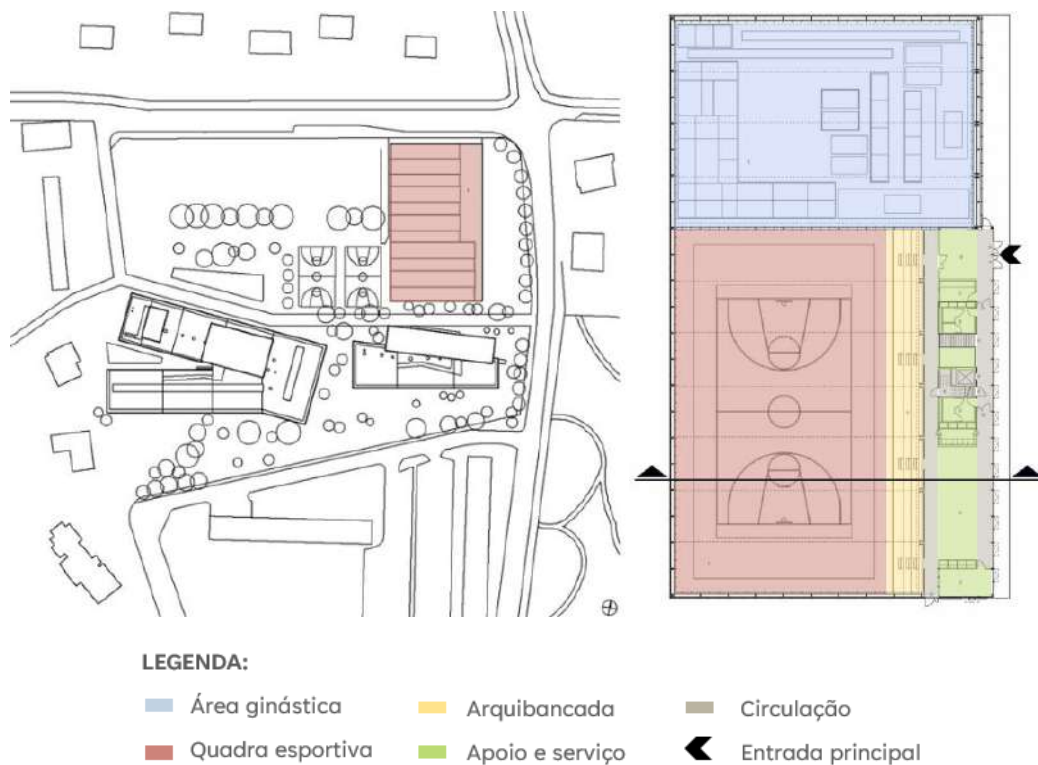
Implantação e planta baixa / Fonte: Archdaily
